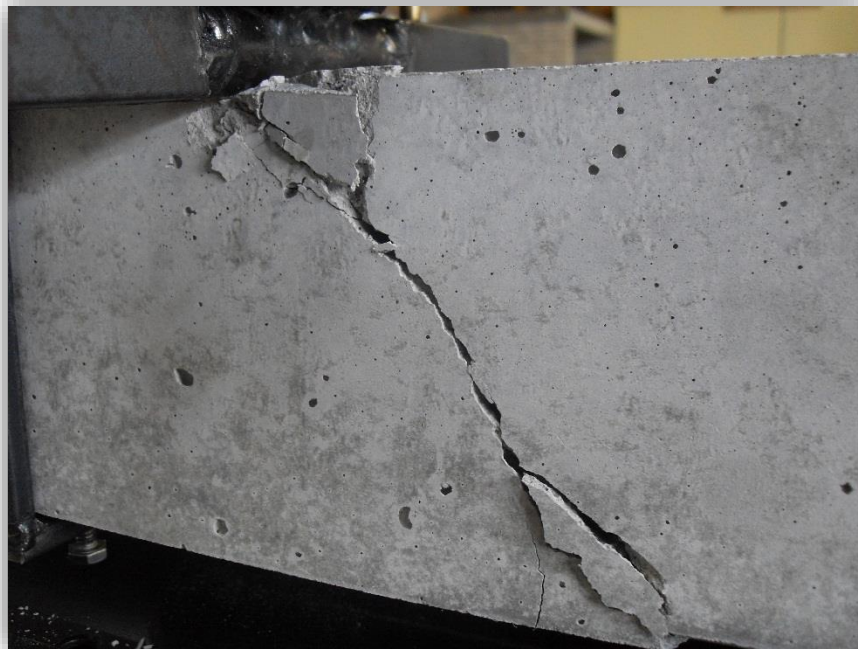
Falla del elemento después de la aplicación de la carga máxima de la viga VCA2
